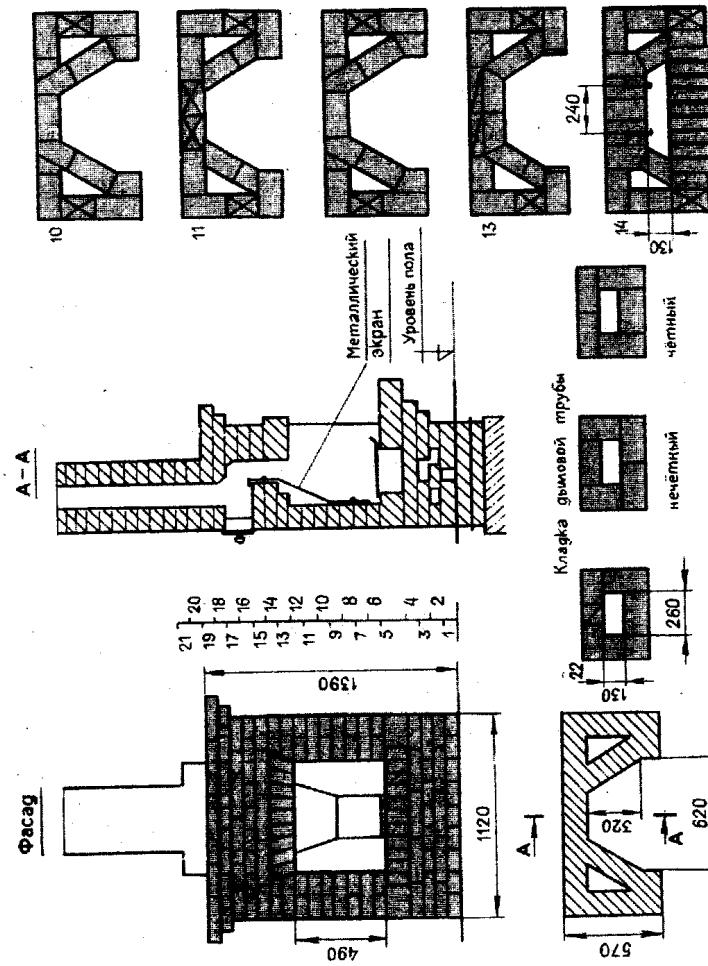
Камин для помещения площадью 20 м² – упрощенный вариант кладки
